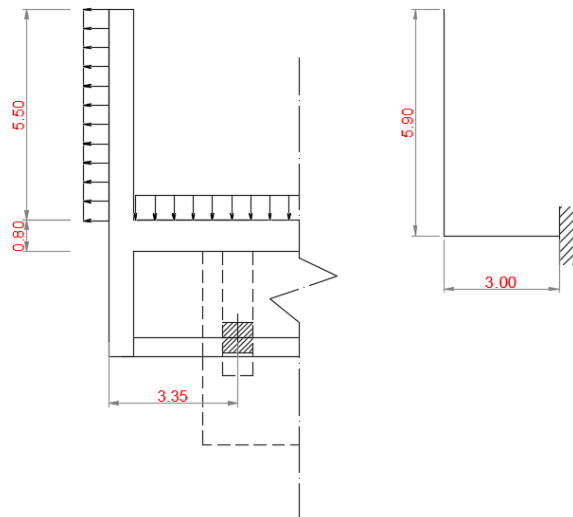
Modelo de cálculo para a acção dos impulsos de terras na viga de estribo do encontro E1
